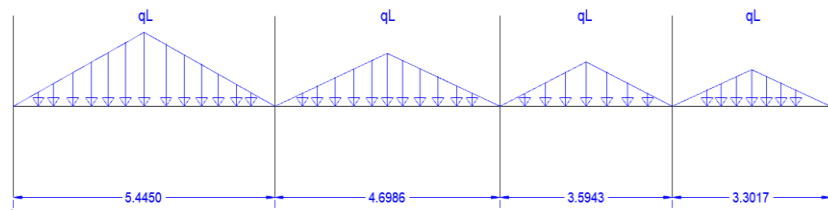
13 Carga muerta lineal en viga eje y del sistema aperticado con muros de corte.
